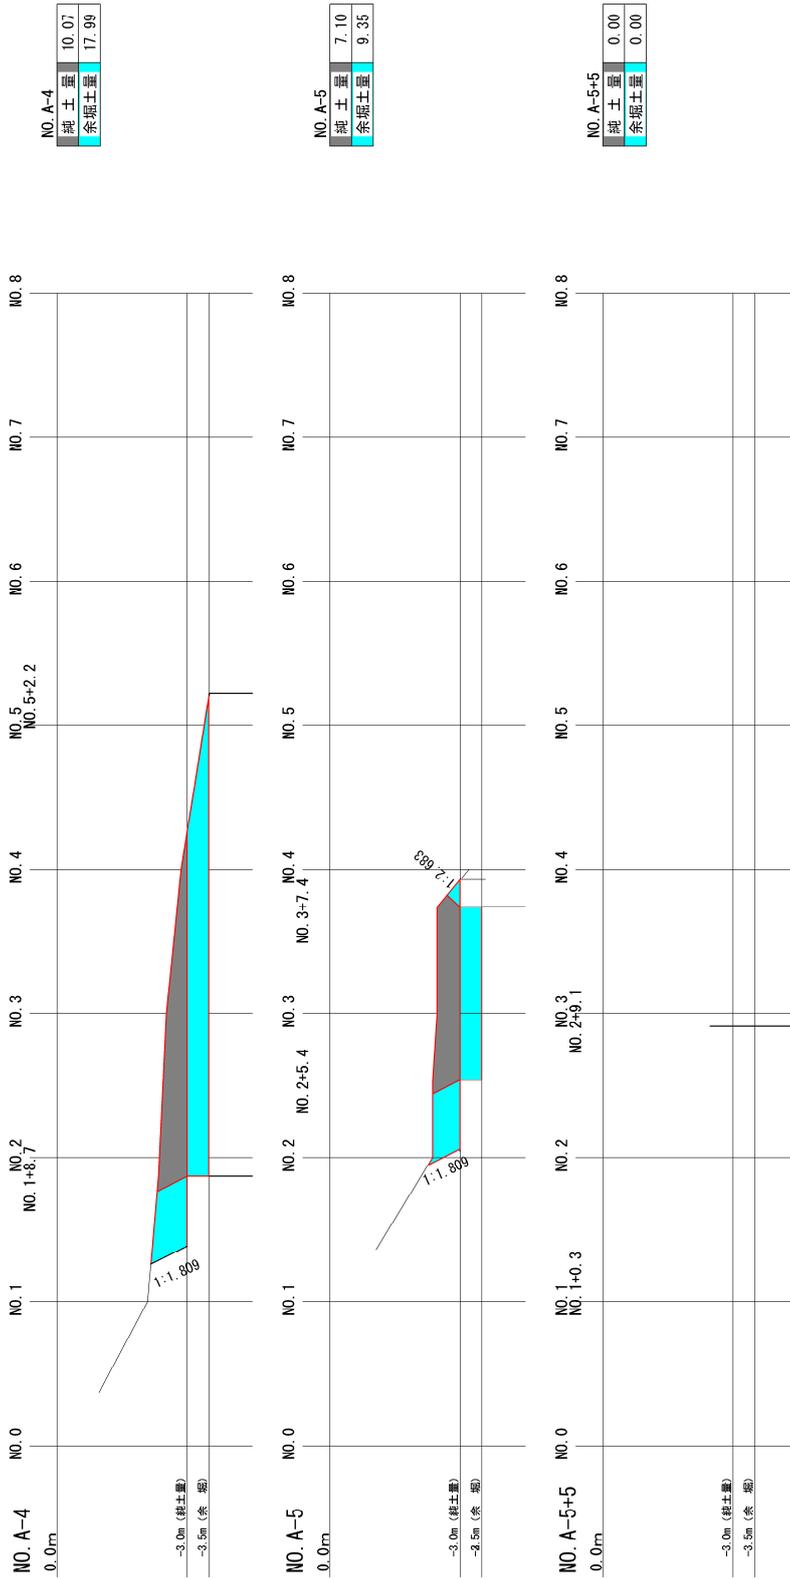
(2) 横断面 (A区) (測線 No. A-4~A-5+5)
